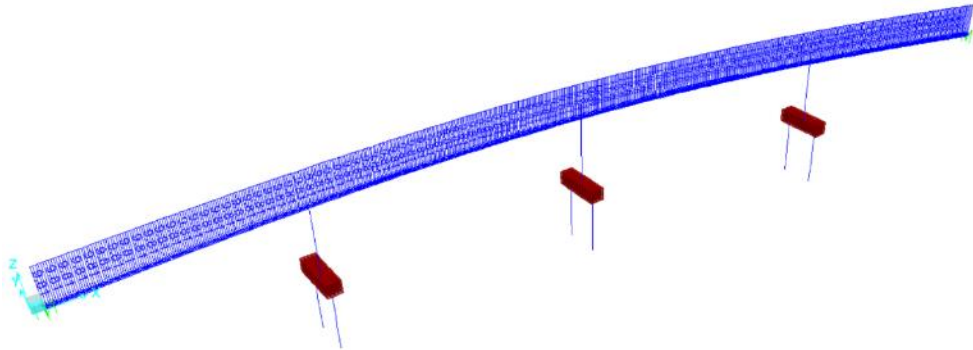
Carga de barrera tipo New Jersey puente Vía a Minca
